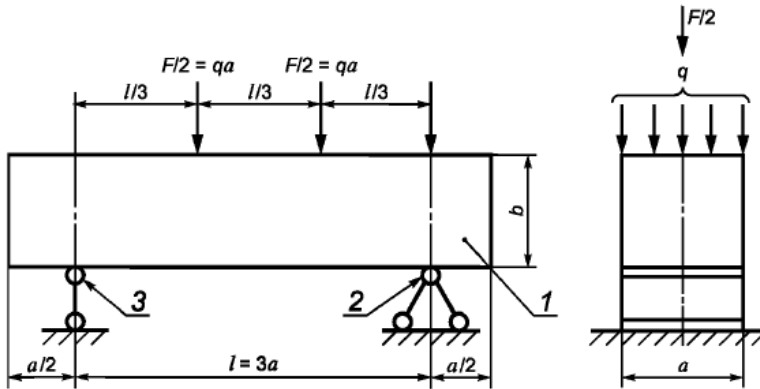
Схема испытания на растяжение при изгибе: 1 – образец; 2 – шарнирно-неподвижная опора; 3 – шарнирно-подвижная опора (a , b – ширина и высота образца; F – нагрузка; q – распределенная нагрузка; l – пролет)
